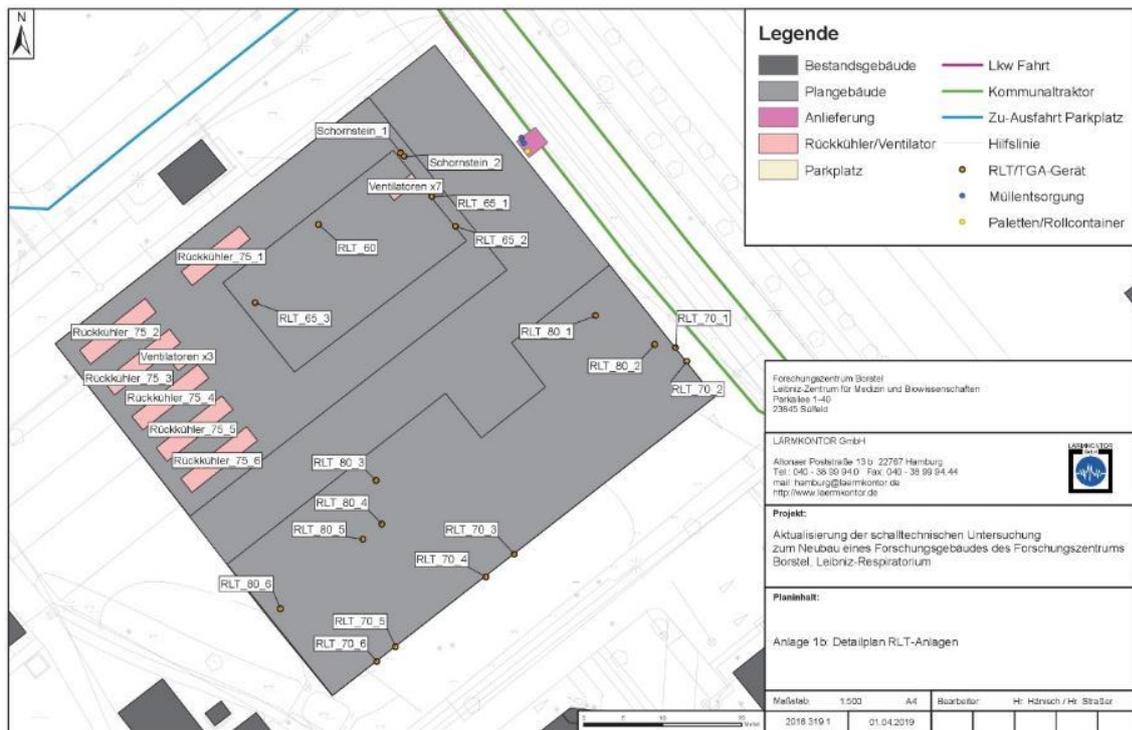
Anlage 1b der schalltechnischen Untersuchung: Detailplan RLT-Anlagen
